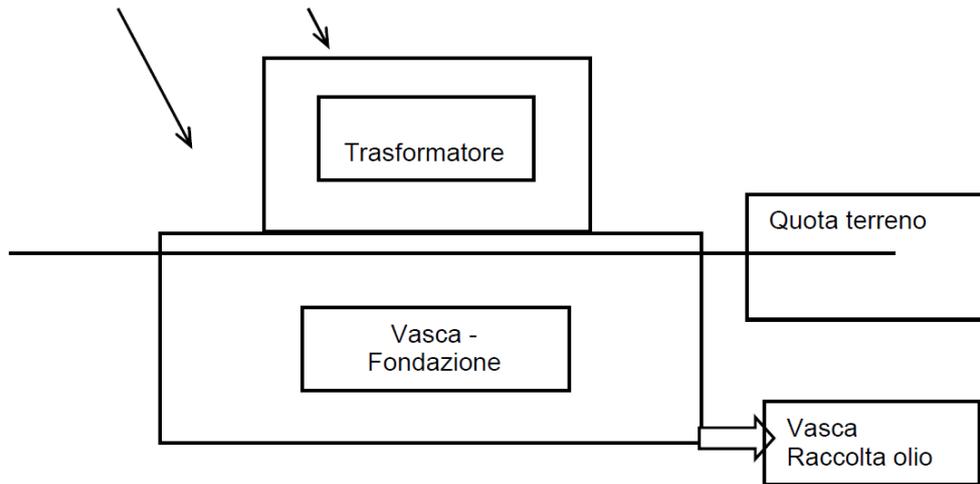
SCHEMA DELLA FUNZIONE VASCA FONDAZIONE
